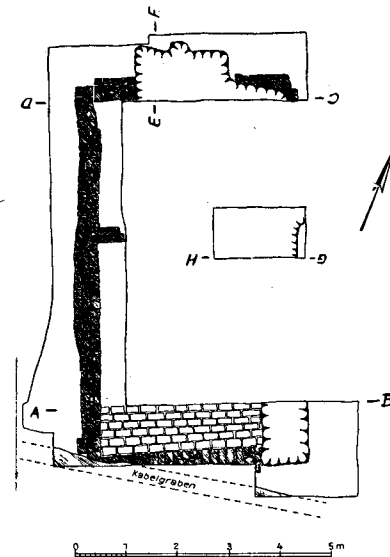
Grundriß des Klostergebäudes. M. 1:100
